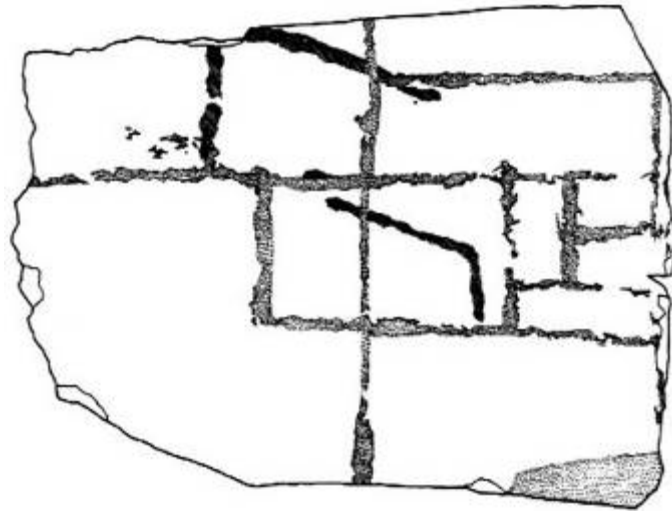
Grundriss-Skizze eines Hauses<sup>979</sup>
